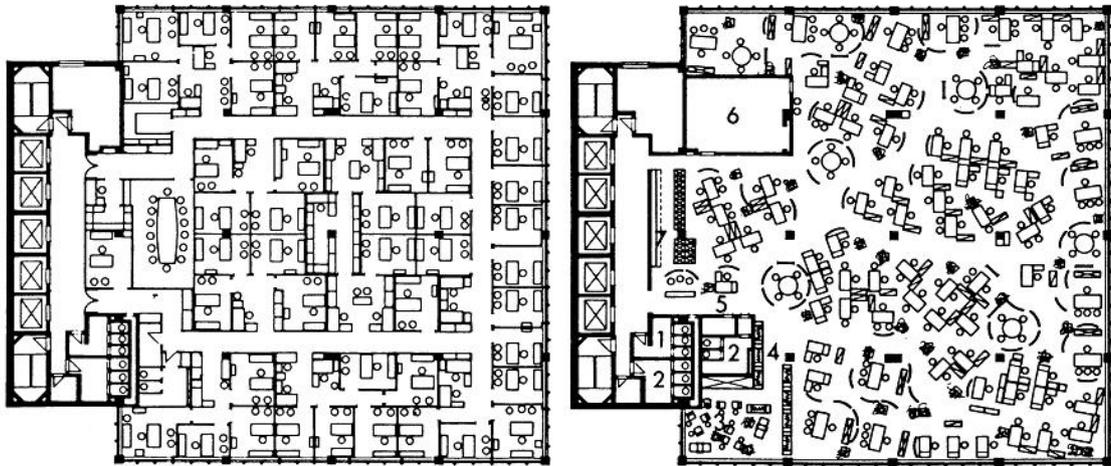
Vergleich zwischen den typischen orthogonalen Bürogrundriss und den Bürolandschafts Grundriss.
